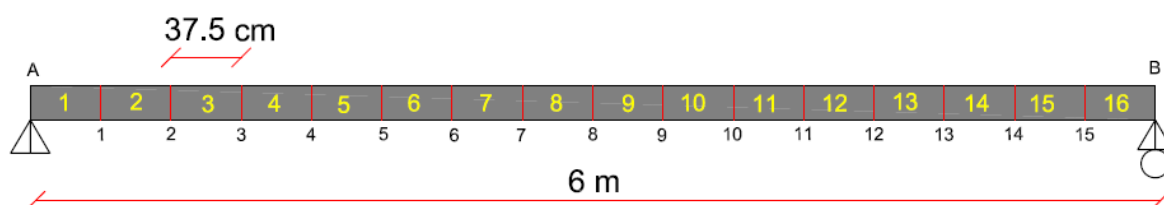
Panorama das vigas ensaiadas (Palechor, 2013)
